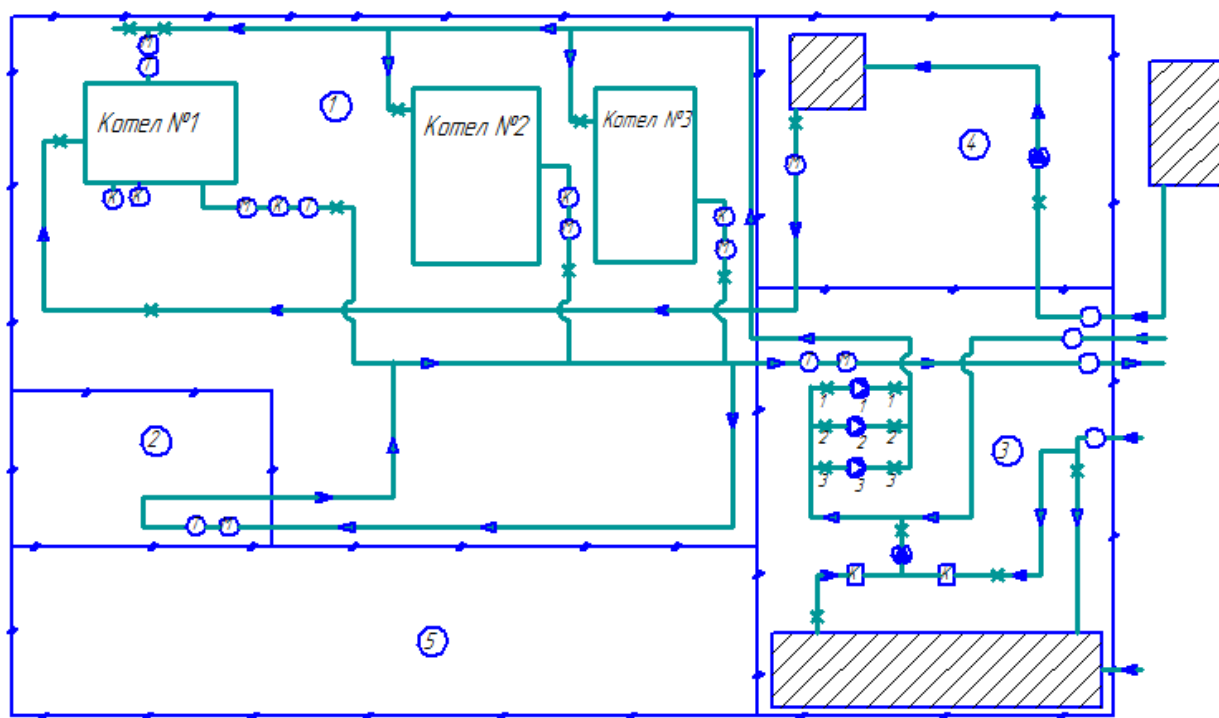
Тепловая схема котельной № 3: 1 – котельный цех; 2 – операторная; 3 – насосная; 4 – нефтеподкачка; 5 – подсобное помещение (склад угля)
